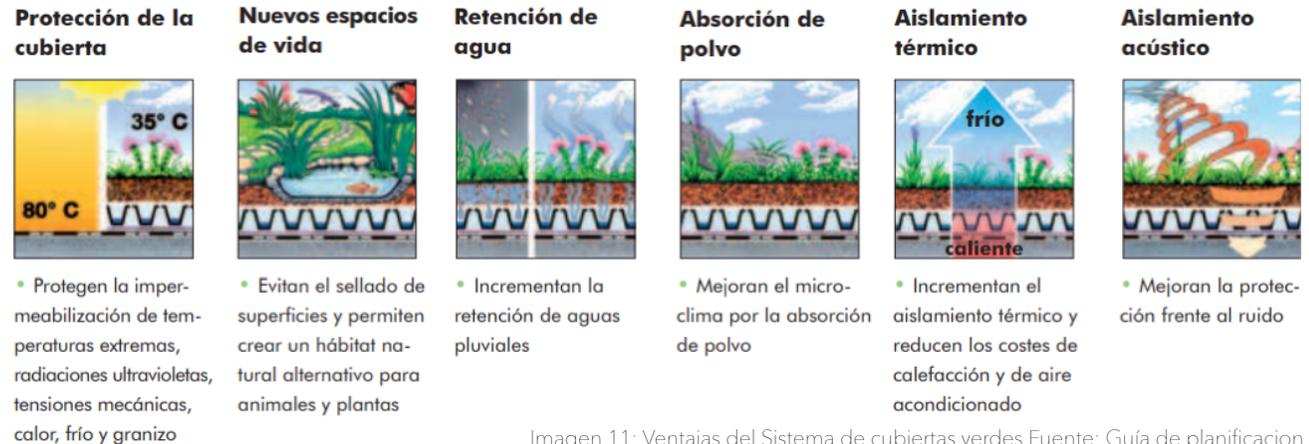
Ventajas del Sistema de cubiertas verdes Fuente: Guía de planificación. Cubiertas verdes 4.0, Zinco
